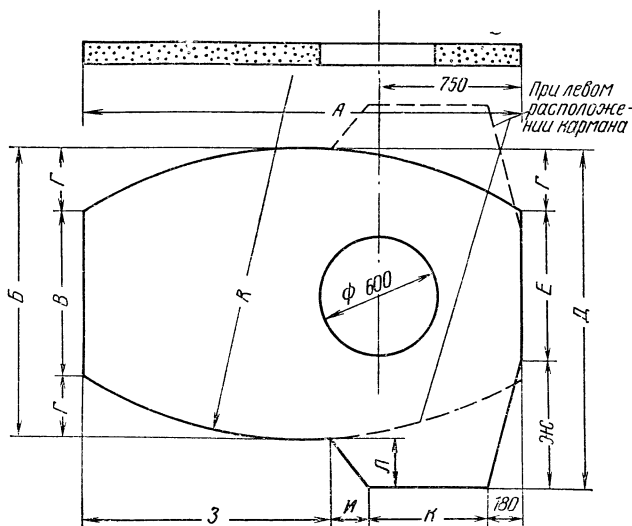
Железобетонные перекрытия для угловых кирпичных колодцев типов ККС-3, ККС-4 и ККС-5
